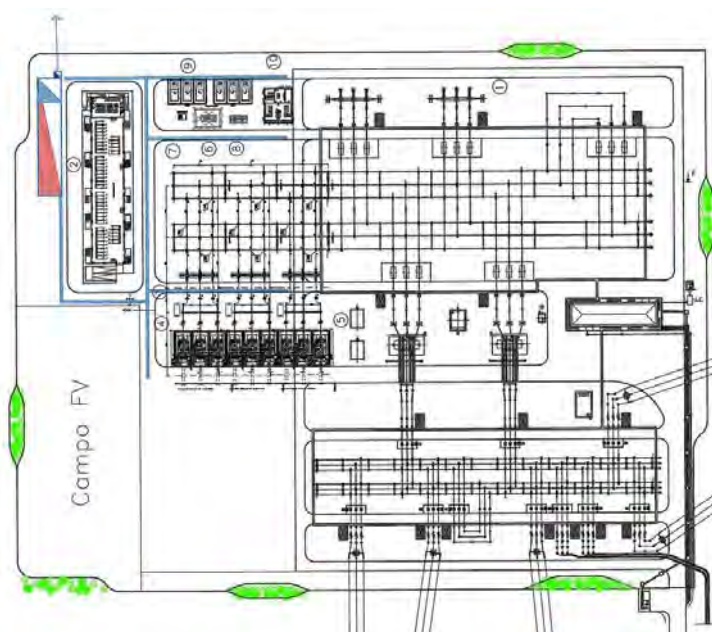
Planimetria dell'ampliamento SE CARPI-FOSSOLI
